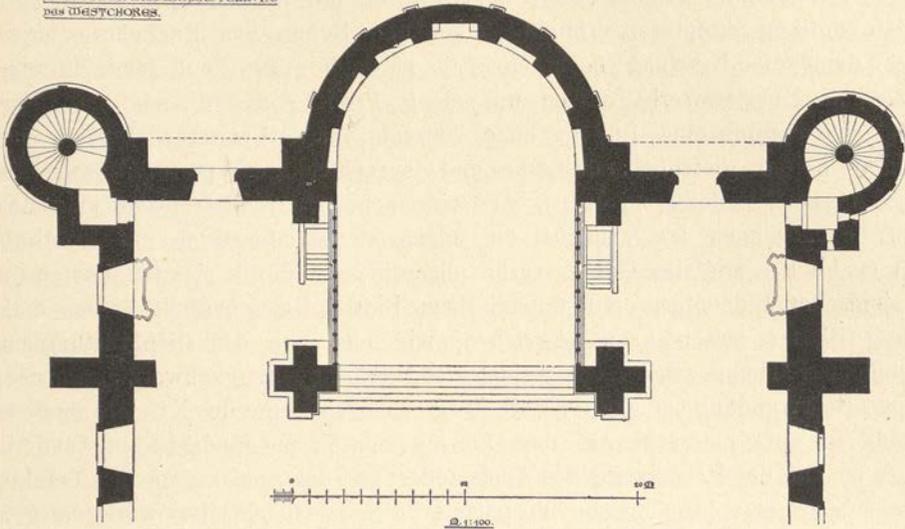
Trier. Dom. Grundriss des Westchors. 12. Jahrh.
